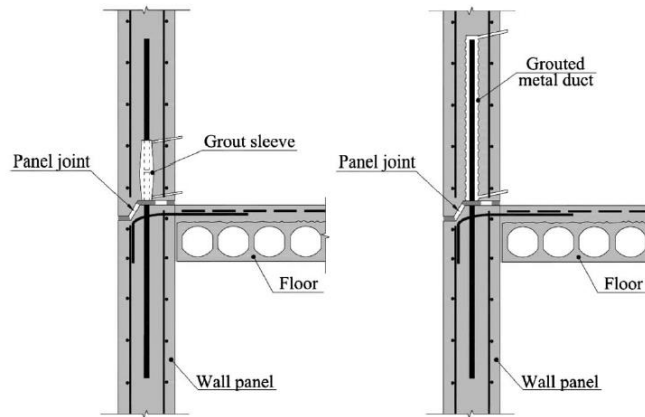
Conexiones horizontales mediante ductos metálicos (derecha) y grout sleeve (izquierda) Kurama et. al (2018)
